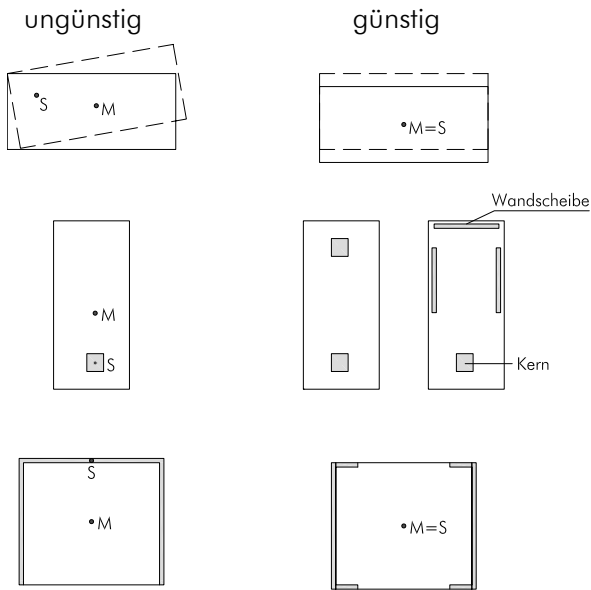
Massen- und Steifigkeitsverteilung im Grundriss
